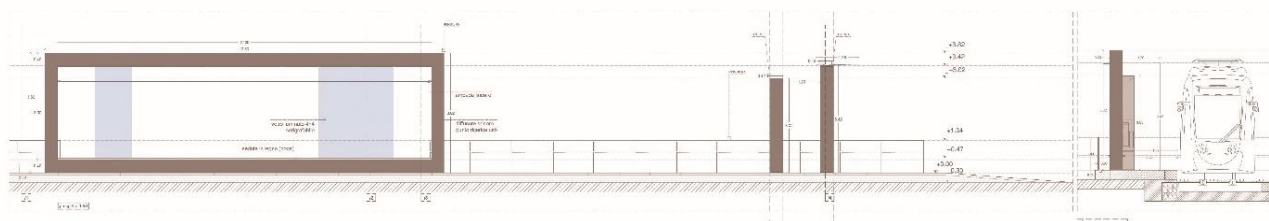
Pensilina di fermata – Prospetto e sezione trasversale
